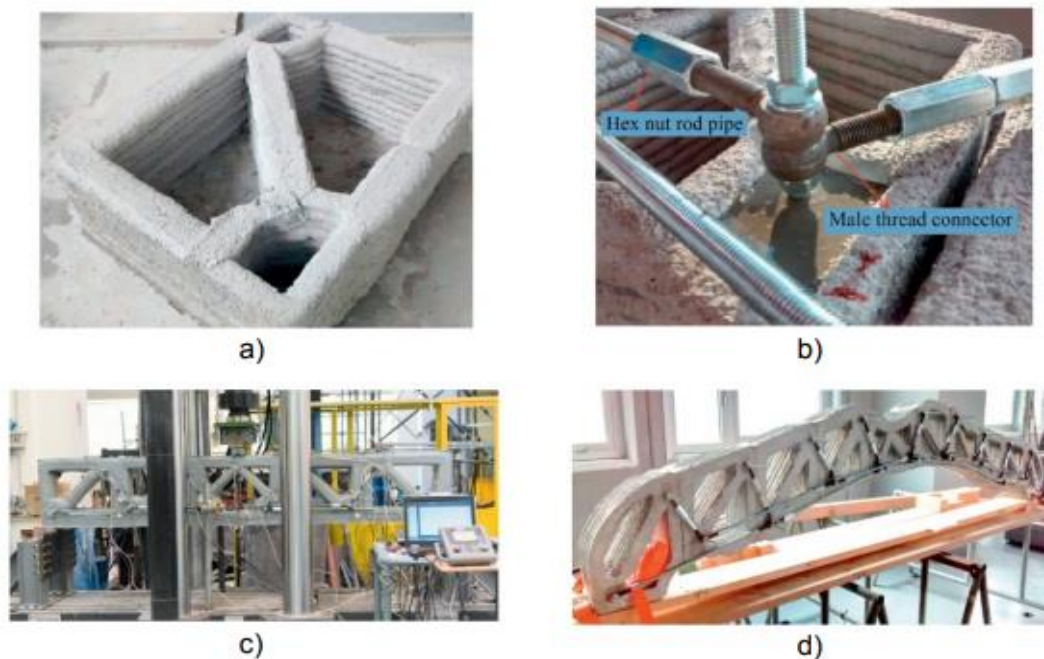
Exemple de renforts externes : a) segment en béton imprimé 3D ; b) détails de raccordement des armatures extérieures en acier ; c) poutres à section droite ; d) poutres à section variable obtenues par montage des armatures externes [6].
